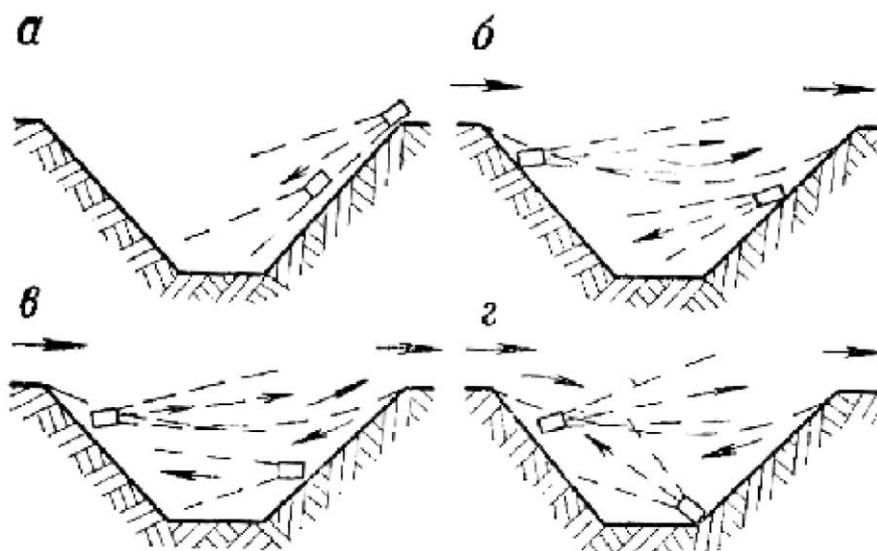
Схемы вентиляции глубокого карьера двумя последовательно работающими вентиляторными установками
